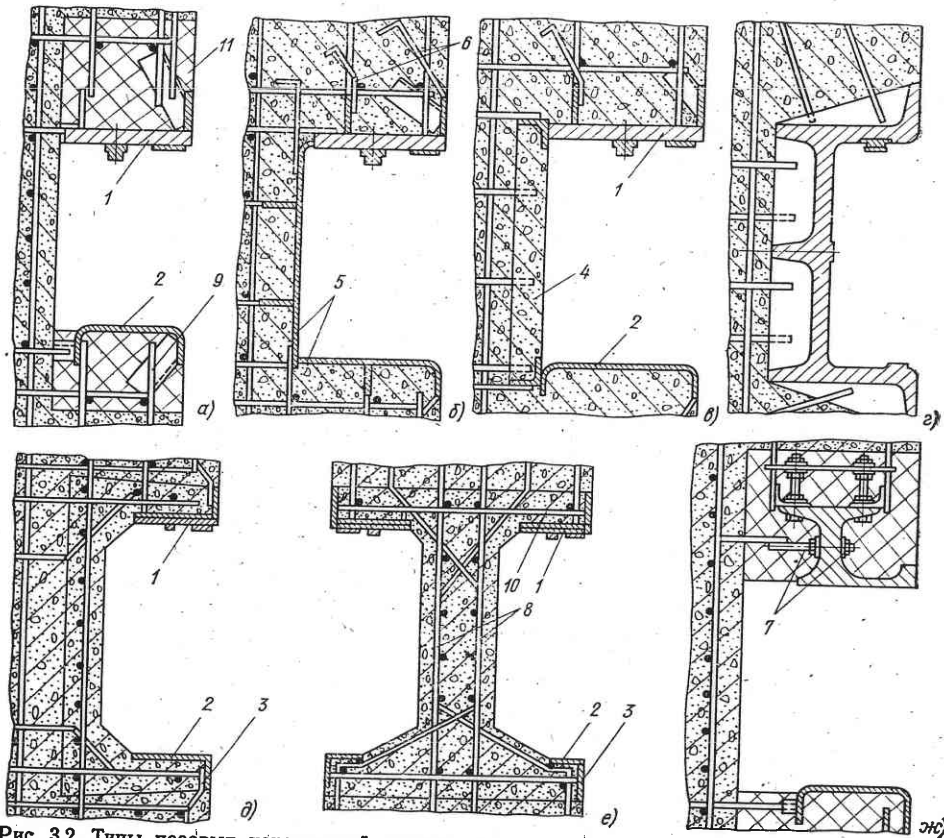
Типы пазовых конструкций плоских скользящих и колесных затворов: а — закладные части в штрабах; б — металлическая пазовая конструкция; в — комбинированная с железобетонной плитой в торце паза; г — литой паз; д — обетонированный однопазовый блок; е — обетонированный двухпазовый блок; ж — закладные части колесного затвора в штрабах; 1 — рабочий путь; 2 — обратный путь; 3 — боковой путь; 4 — торцевая железобетонная панель; 5 — облицовка паза; 6 — элементы закрепления; 7 — временные раскрепления; 8 — элементы для регулирования рабочего пути; 9 — арматура блока; 10 — выпуски арматуры; 11 — предварительно напряженная арматура
